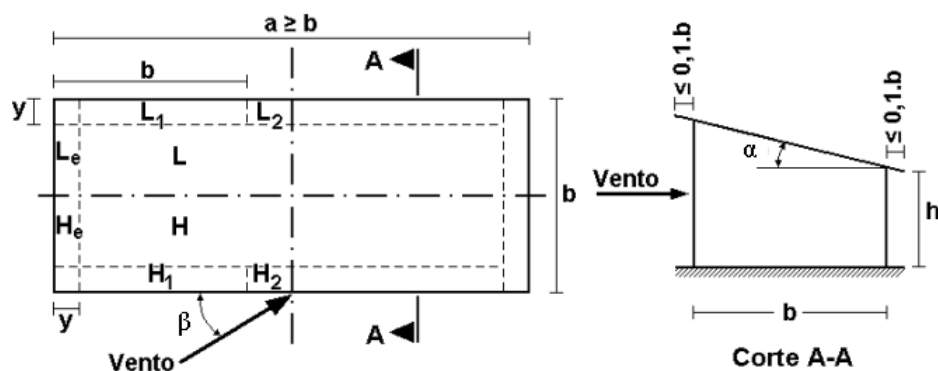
Vista superior e o corte do telhado com uma água em edificações de planta retangular
